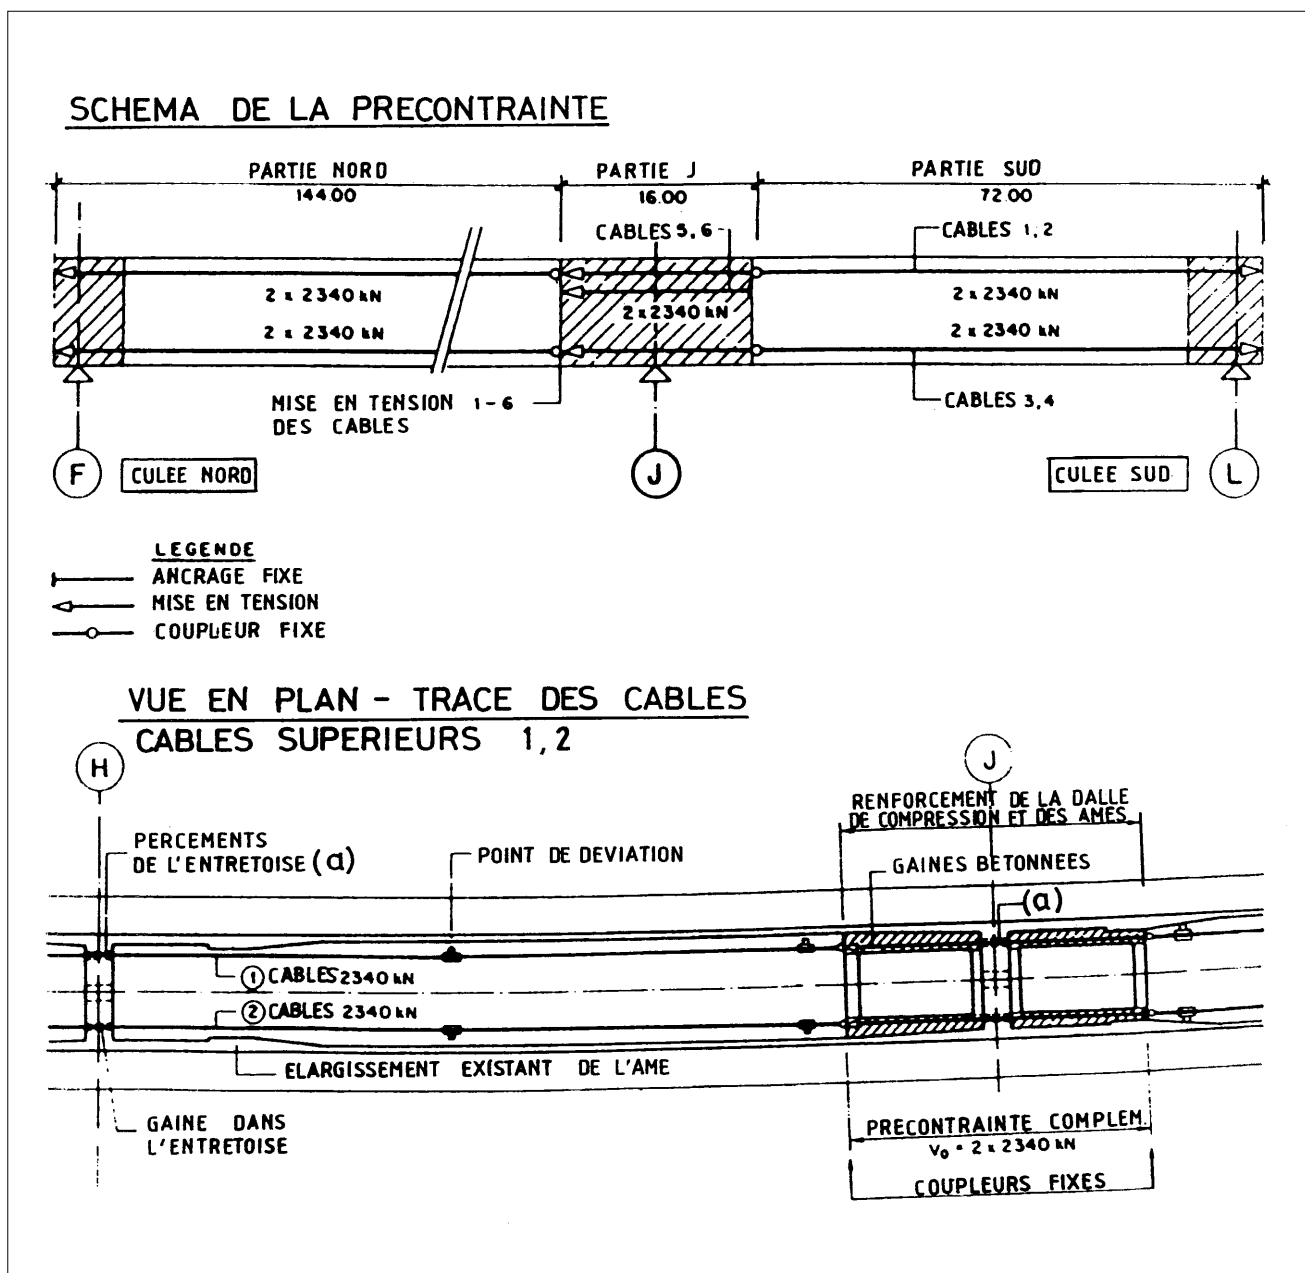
Pont sur la Reuss à Wassen. Disposition de la précontrainte extérieure (Moretti, 1989).
